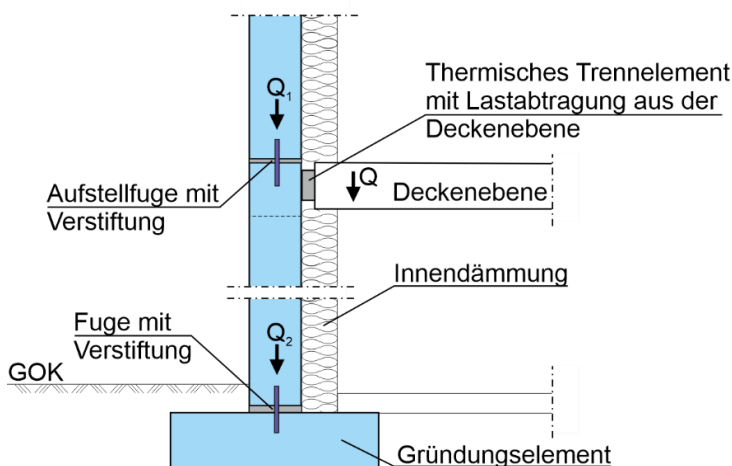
Prinzipielle Fassadenausbildung für die tragende Fassade mit Innendämmung
